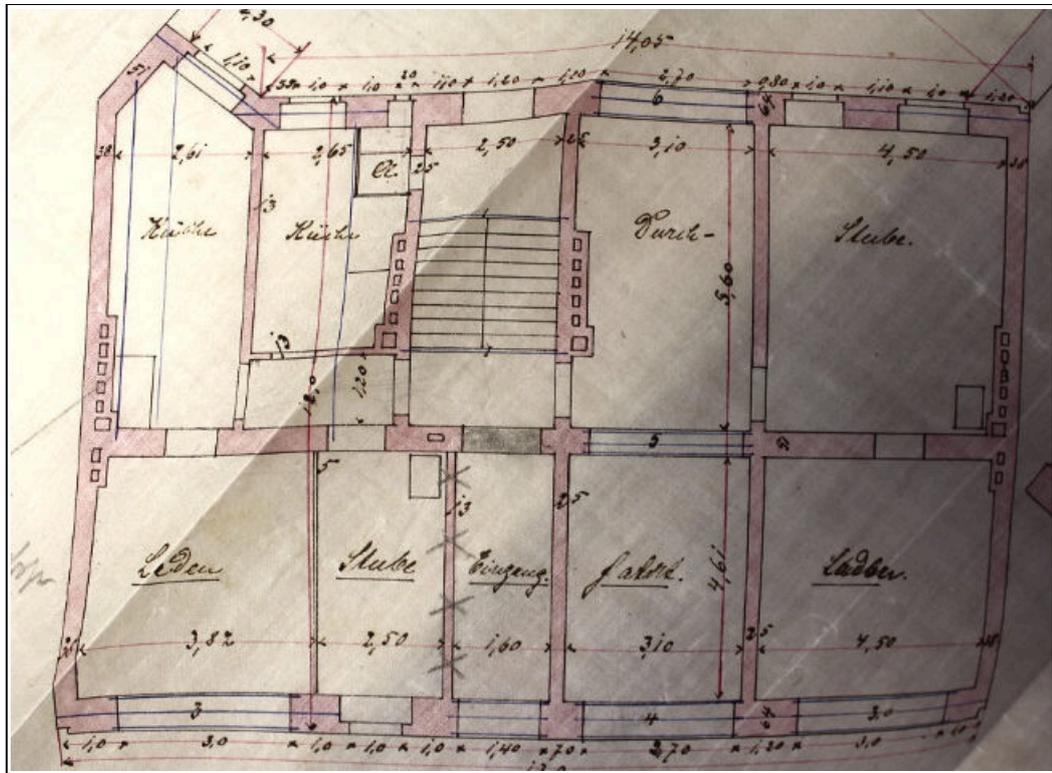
Grundriss Erdgeschoss VH
